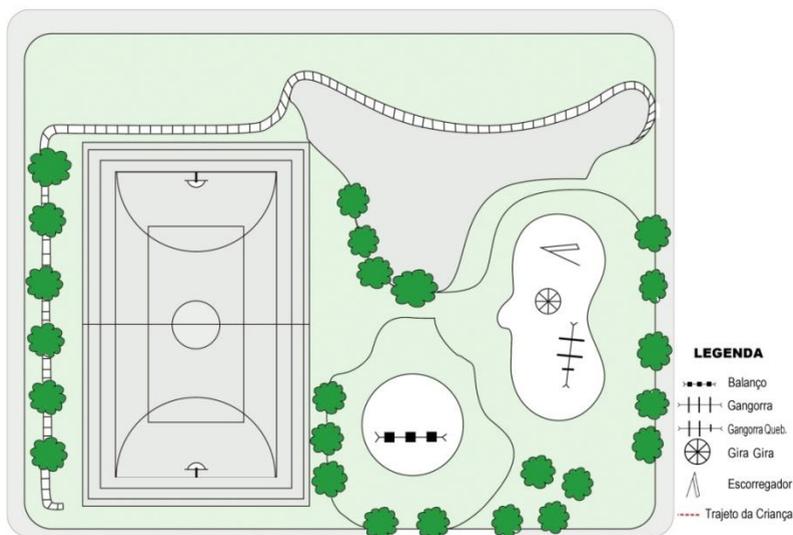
Planta baixa da Praça Florentina de Oliveira Costa.
